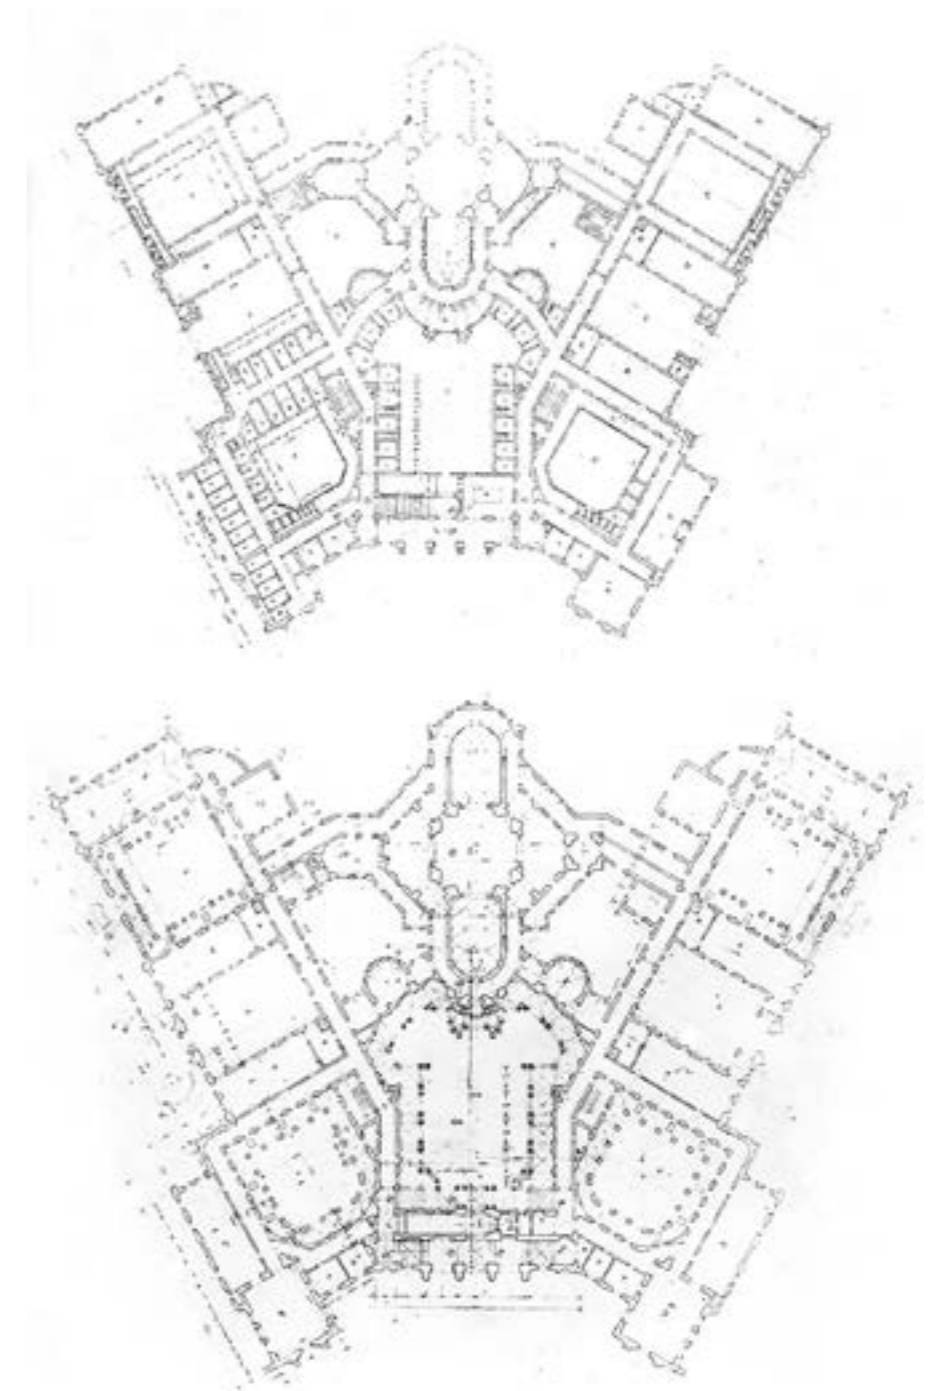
Planta primera del Complesso del Buon Pastore. Editado por el autor a partir de un original tomado de Luca Brasini (Brasini 1979: 73)
